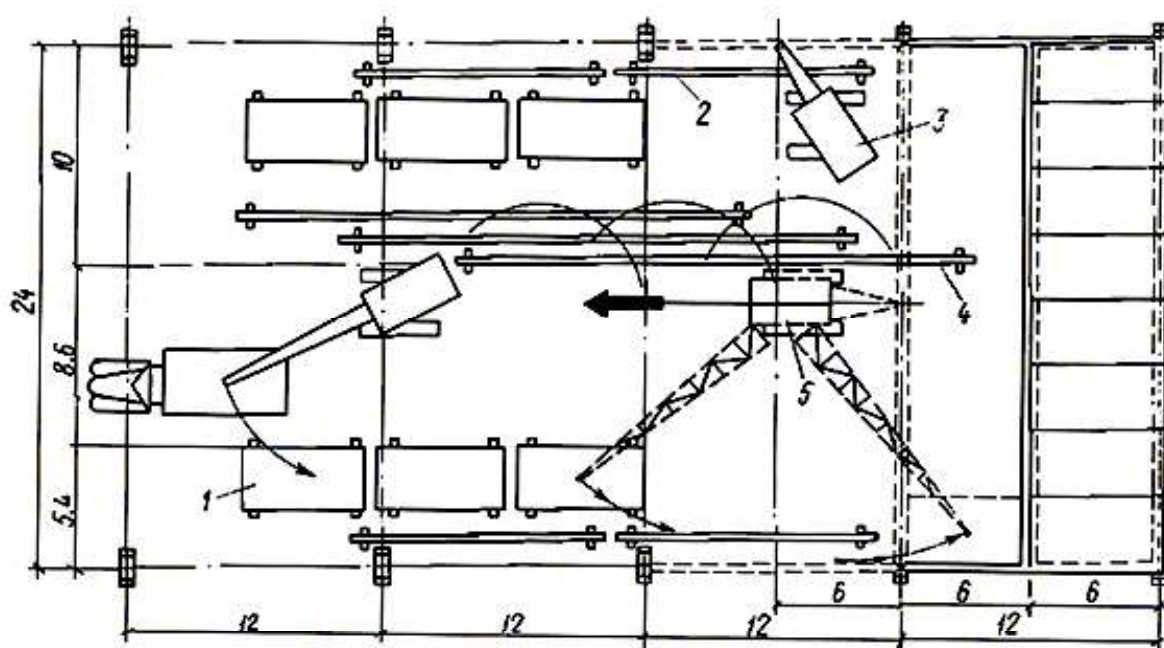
Схема предварительной раскладки конструкций при монтаже покрытия одноэтажного промышленного здания:
